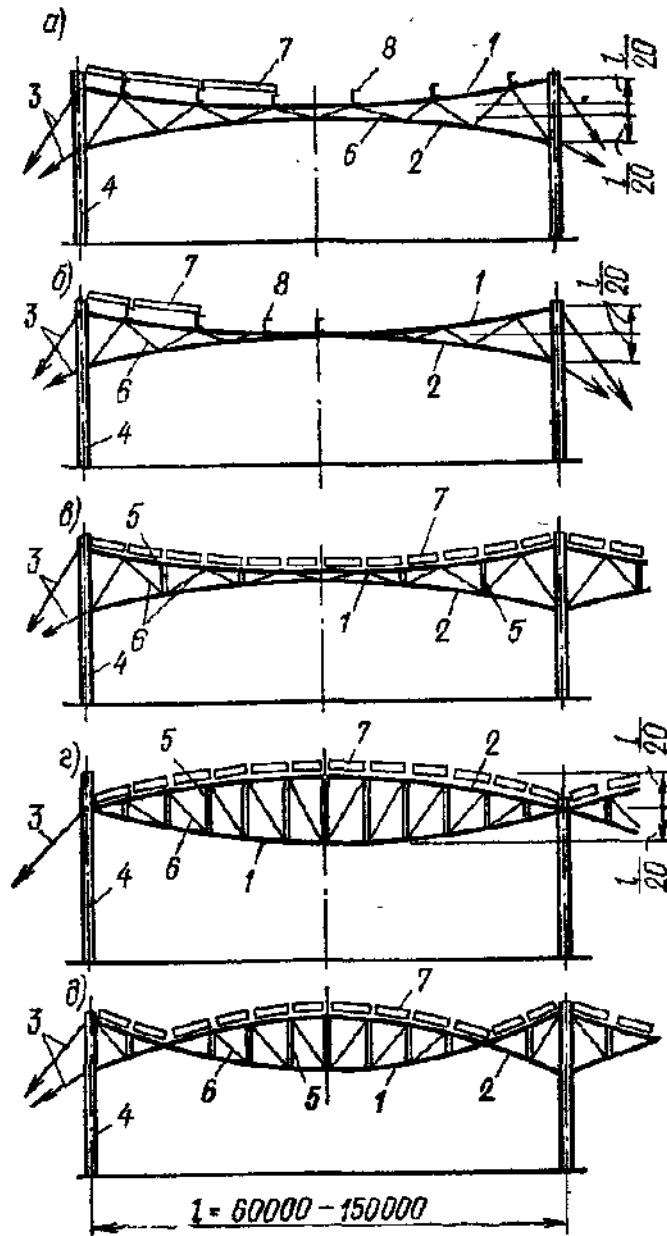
Схемы вантовых предварительно напряженных ферм:
